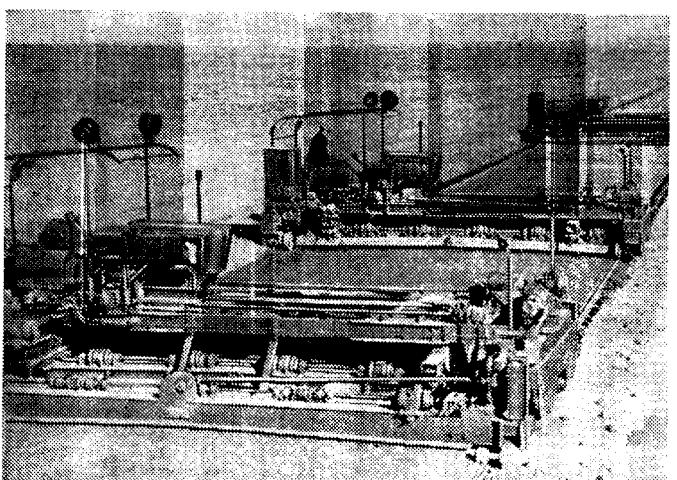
Испытание гидрофицированного комплекта бетоноукладочных машин Николаевского завода на строительстве автомагистрали Алма-Ата — Новоплийск
